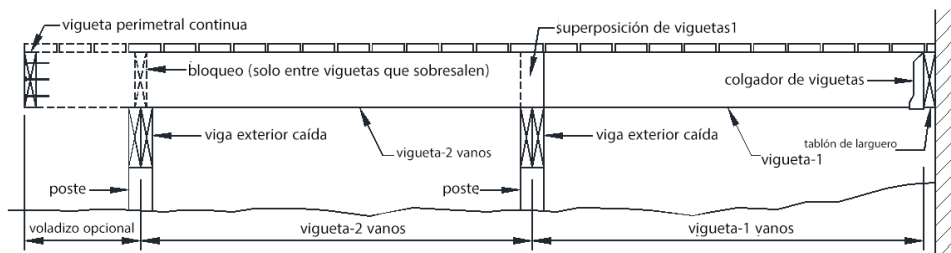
TERRAZA SENCILLA - VIGUETAS FIJAS EN LA CASA CON VIGA AL RAS
